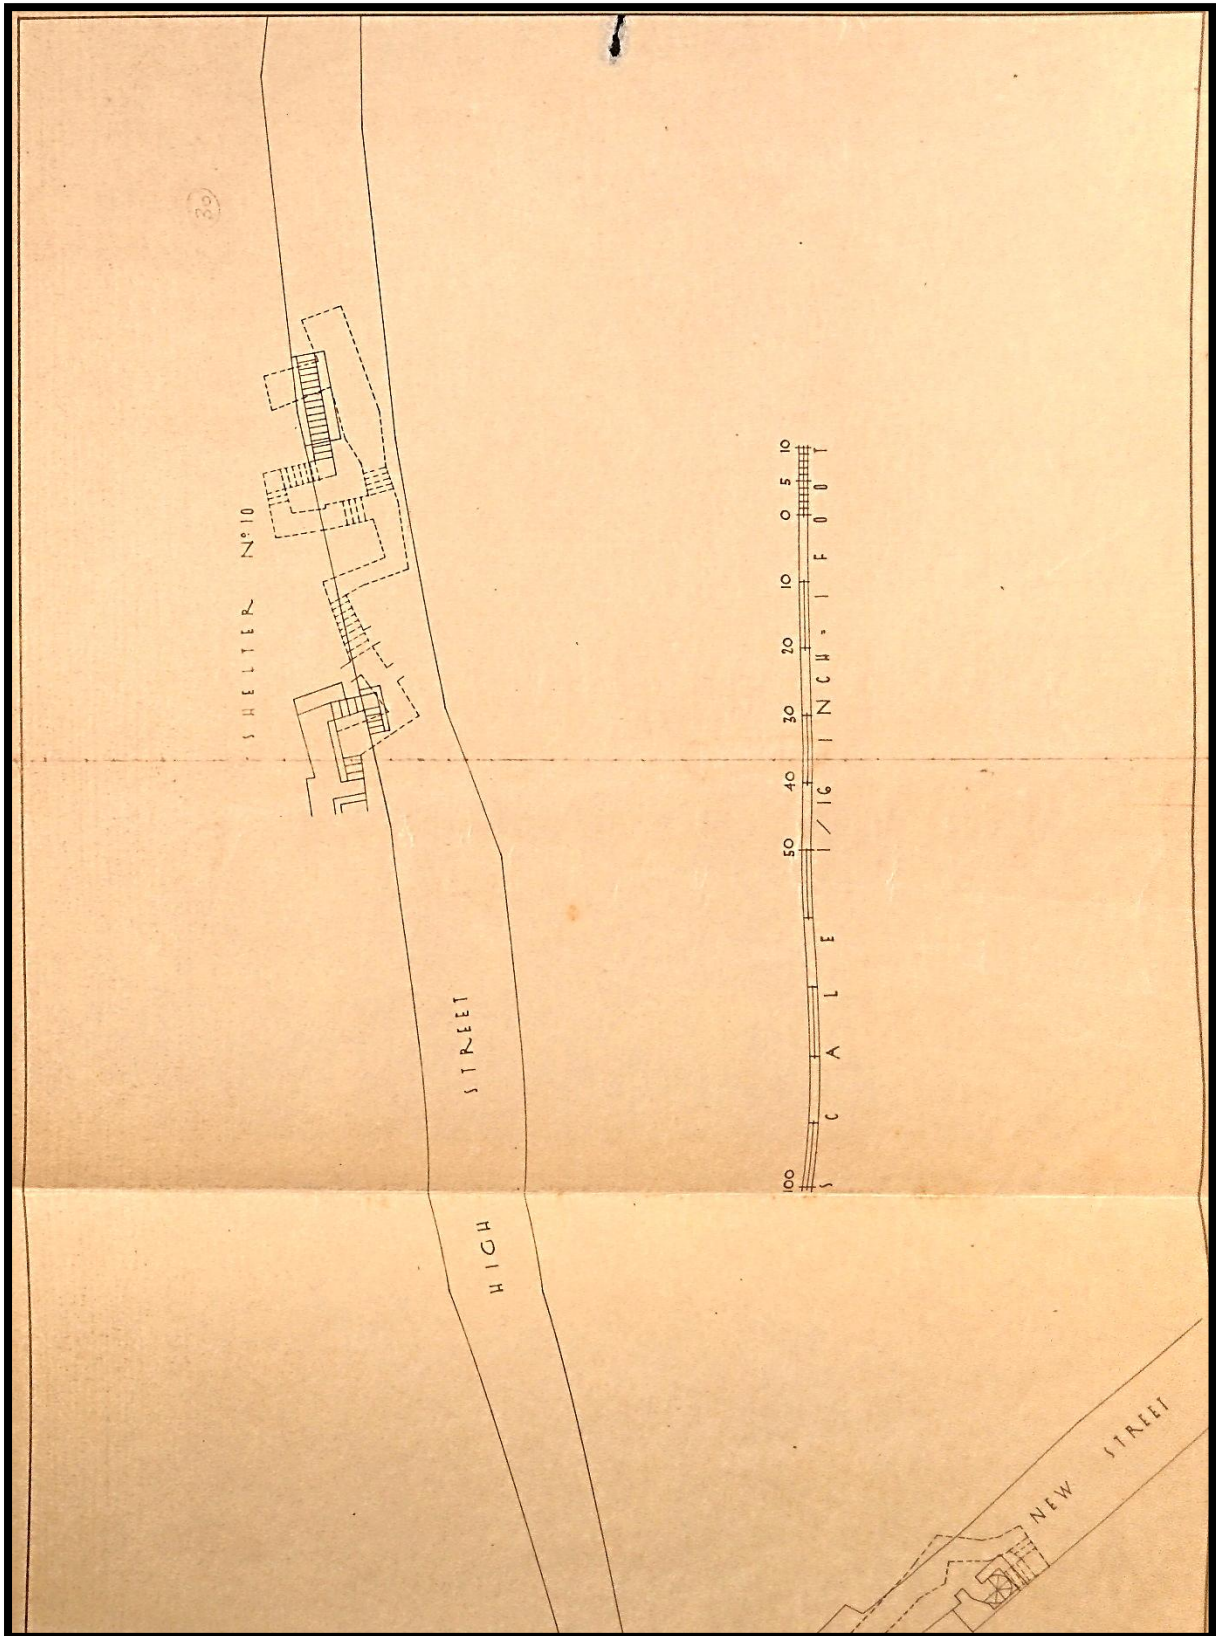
Planta do Abrigo nº 10 e 12 (continuação) "New Street – High Street."
